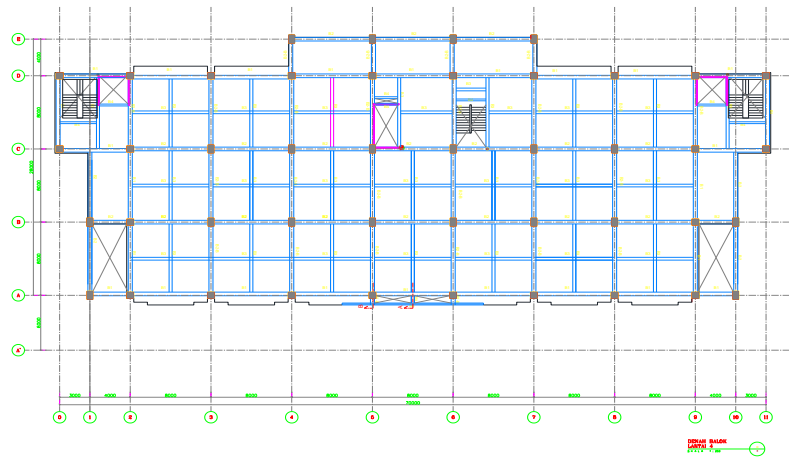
Denah lantai 1 Elevasi 5 meter Pada Gedung Fakultas Ilmu Keolahragaan (FIK) Universitas Negeri Malang
